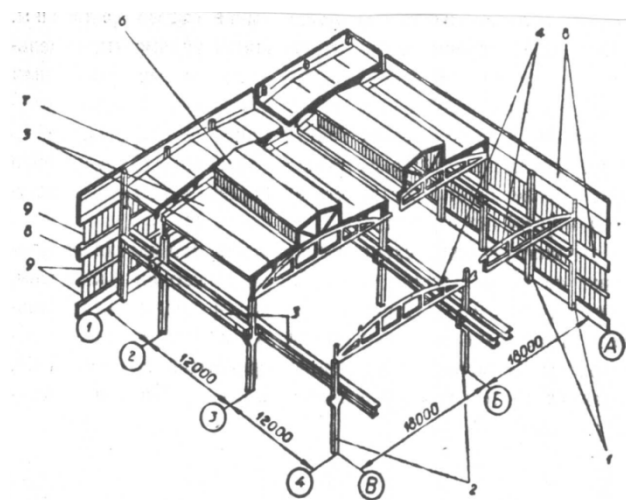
Схема каркаса одноэтажного промышленного здания: 1 – колонны крайнего ряда; 2 – колонны среднего ряда; 3 – подкрановые балки; 4 – фермы покрытия; 5 – плиты покрытия; 6 – фонарь; 7 – парапет; 8 – панели наружных стен; 9 – оконные переплеты.
